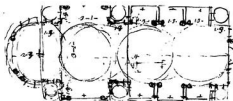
Dibujo de la planta para la "Chiesa del Carmine a Torino" (Juvarra).
